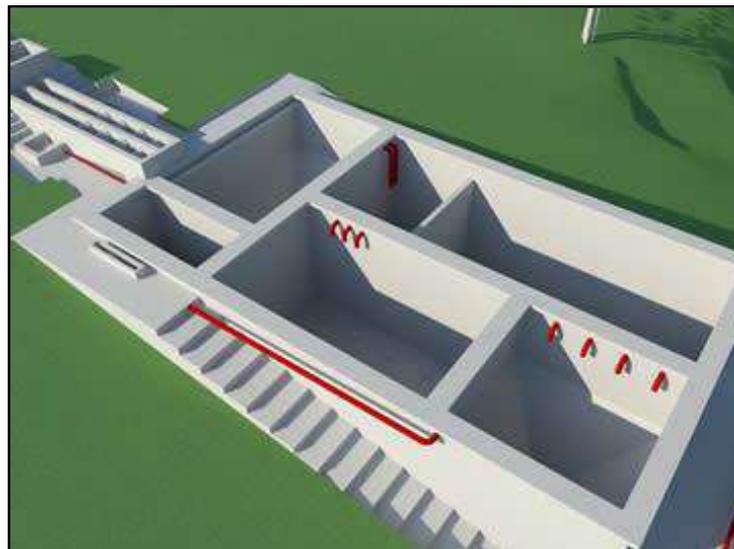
Planta de tratamiento propuesta. (Sistema estructural) FUENTE: Elaboración Propia
